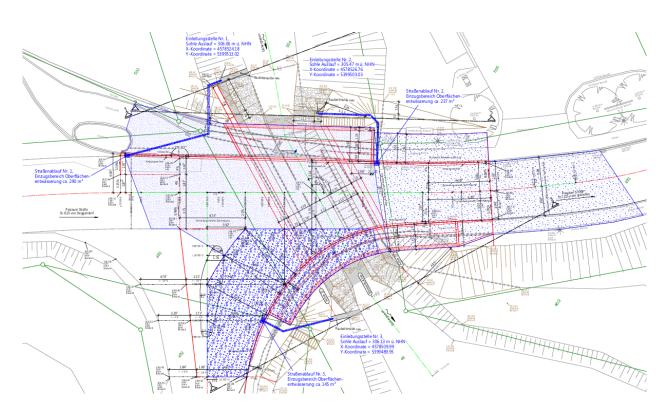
Auszug aus Plan WR 02 - Lageplan Oberflächenentwässerung
